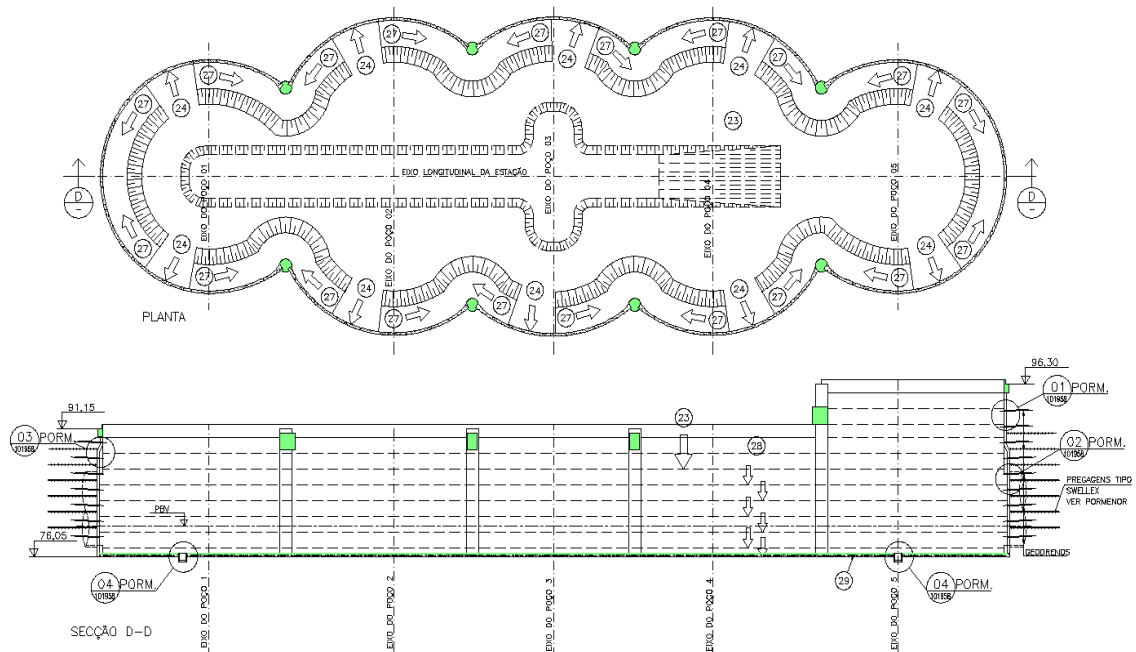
Planta e corte transversal do faseamento construtivo da escavação e revestimento primário (Adaptado CJC, 2009).
